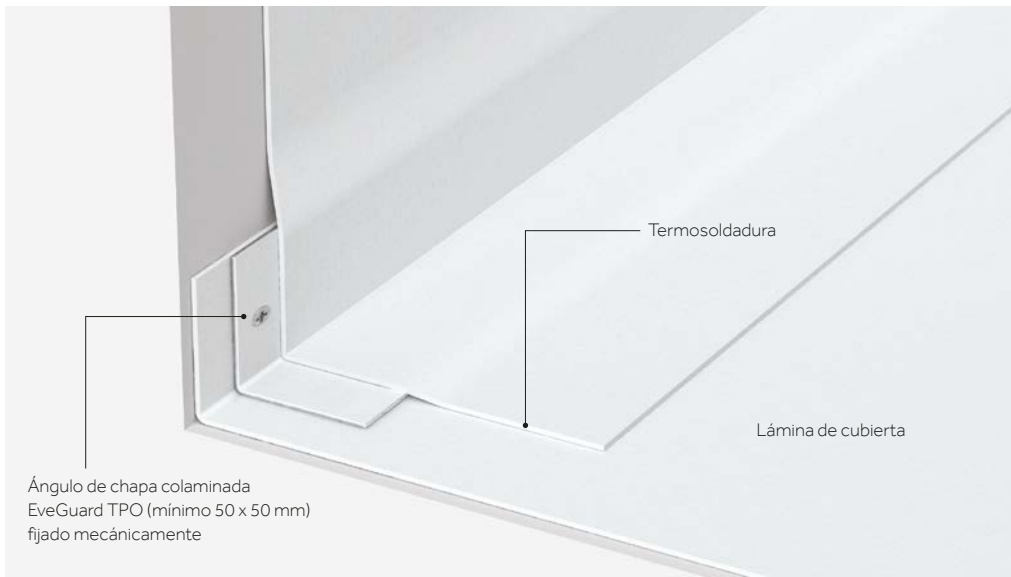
Fijación del perímetro mediante chapa colaminada EverGuard TPO.
